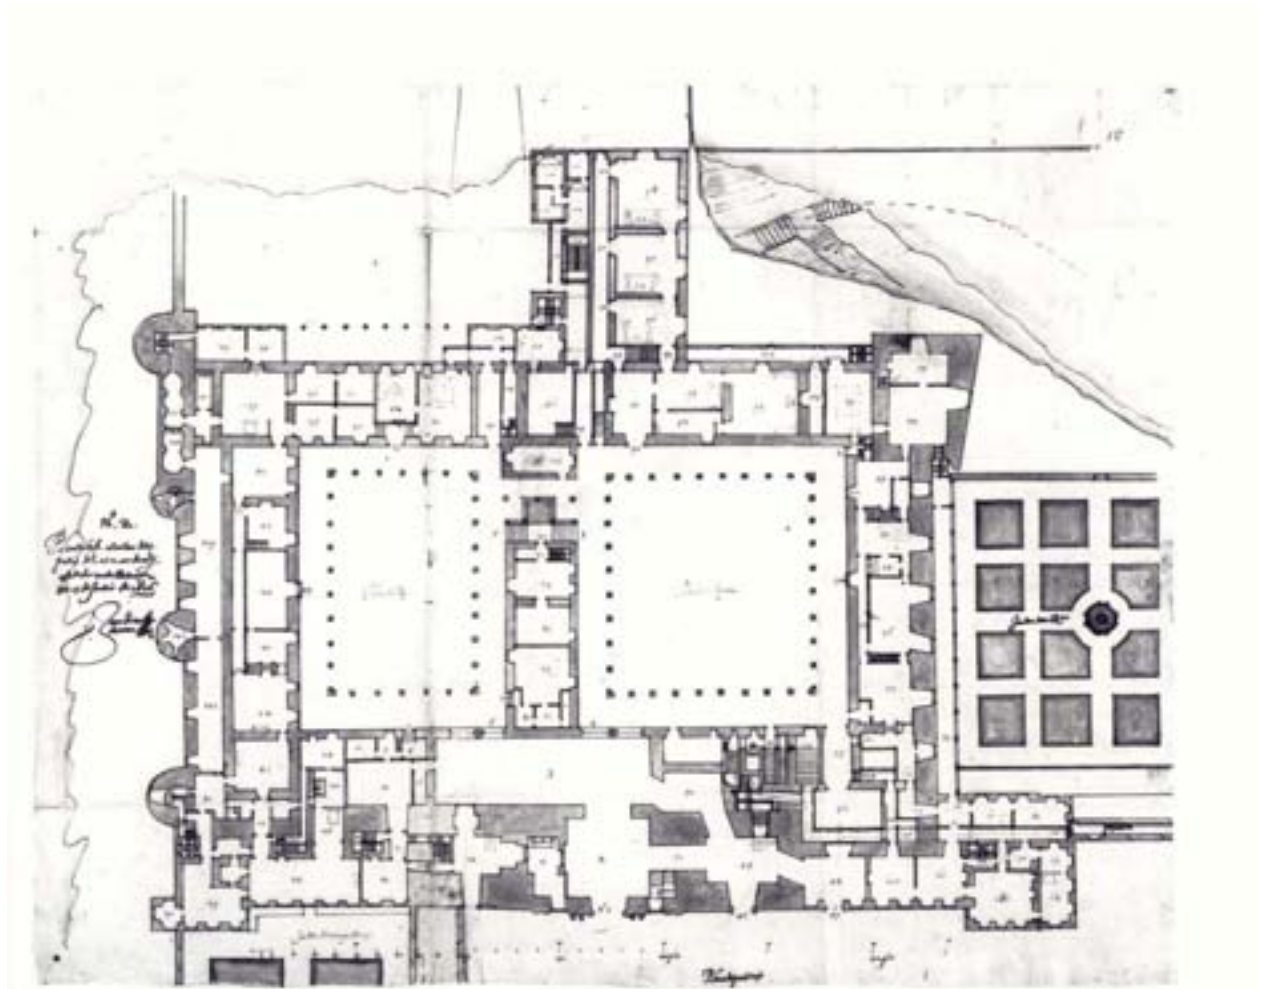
JUAN GÓMEZ DE MORA 1626 Planta baja del Alcázar. Biblioteca Vaticana
